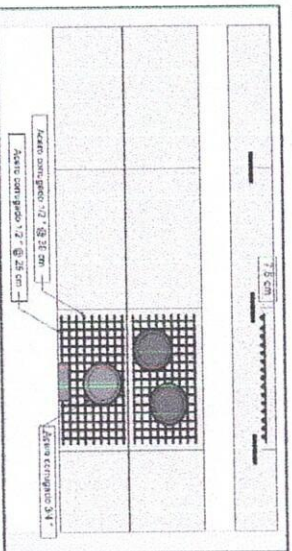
Detalle de refuerzo sobre grupos de manholes
